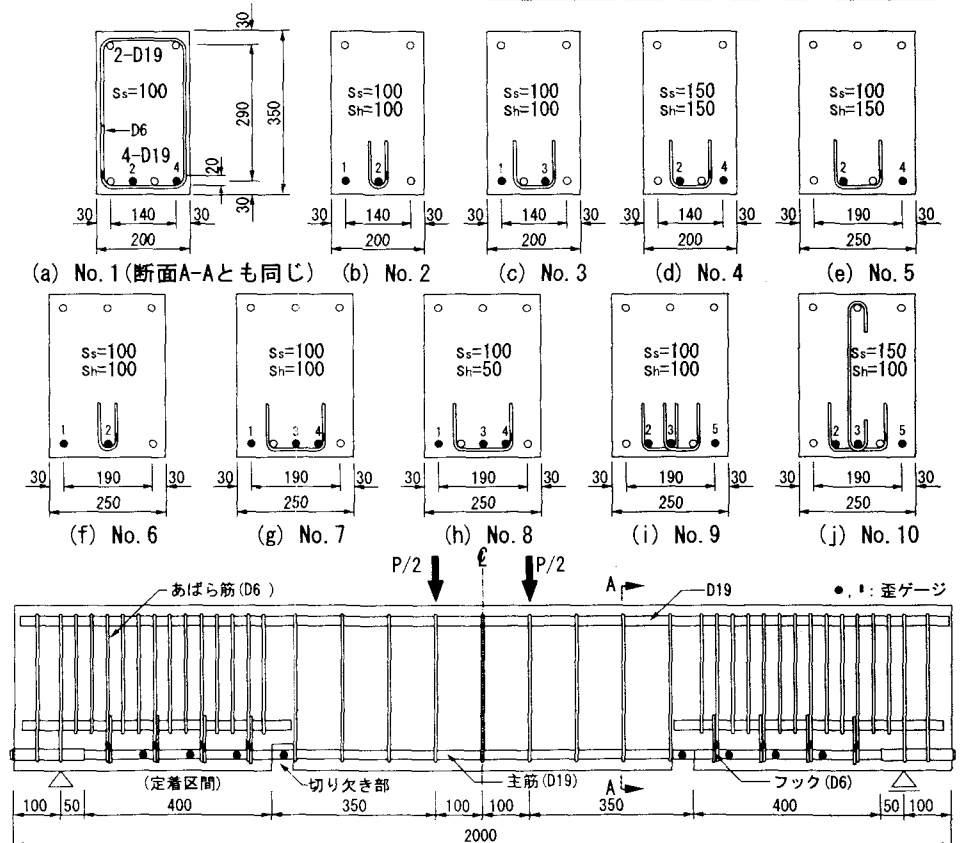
試験体の形状・寸法および荷重・測定方法(単位mm)
